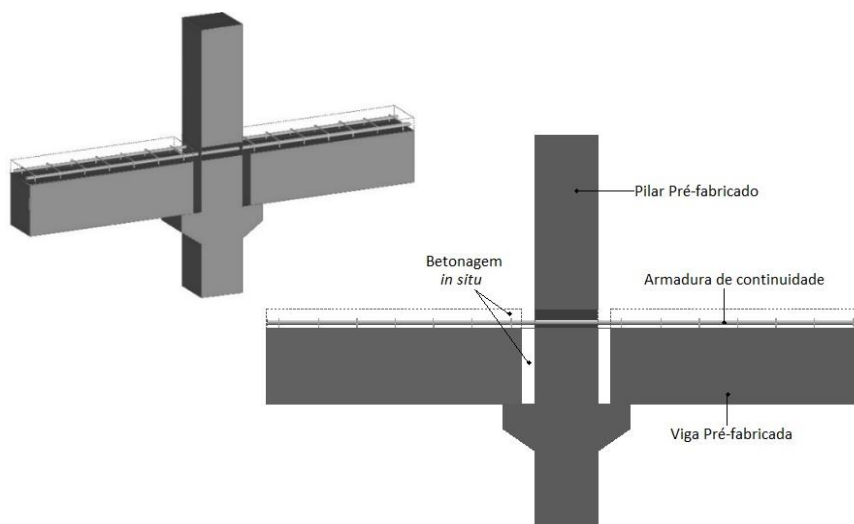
Ligação Viga - Pilar com armadura de continuidade
